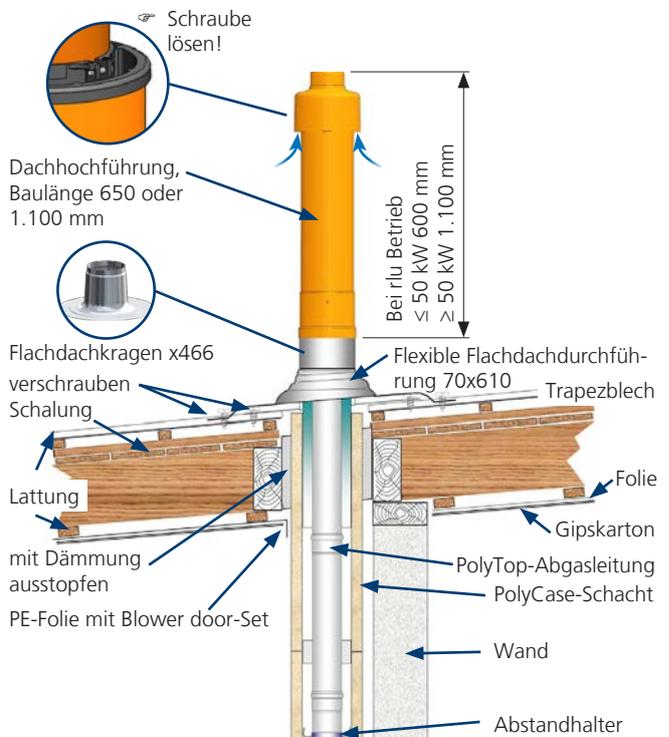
Schnitt Dachdurchführung DN 60/100 - 100/150
